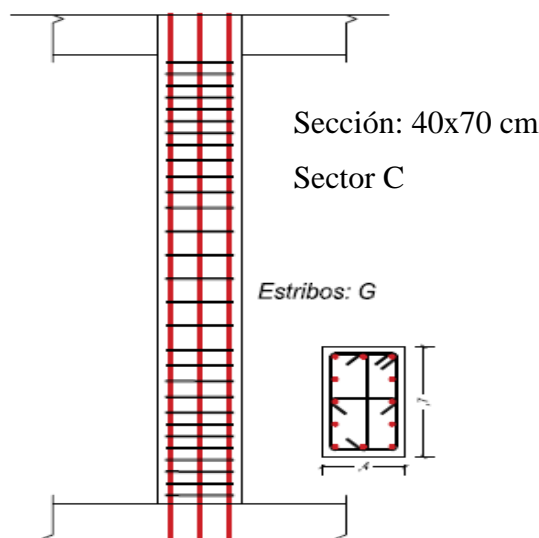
Detalle de Columna en Base Aislada (C)
